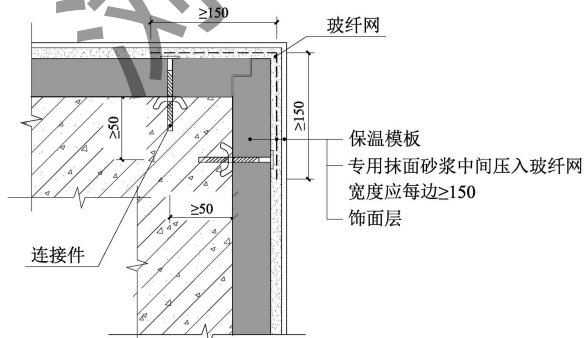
建筑二层及以上阳角部位保温模板安装构造做法
